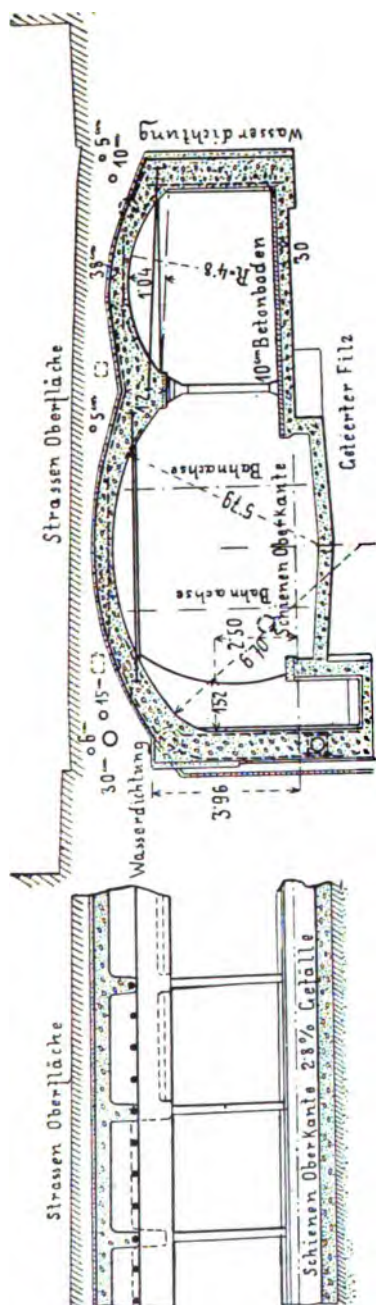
Quer- und Längsschnitt der Haltestelle Old-Court-House des East-Boston-Tunnels.
